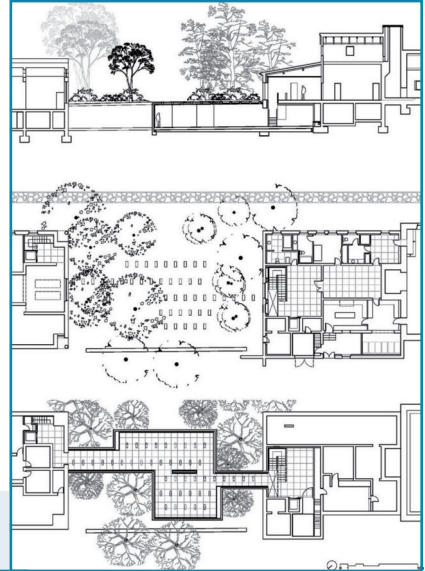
Planta del proyecto. Fotografías: cortesía del estudio Elisa Valero.
